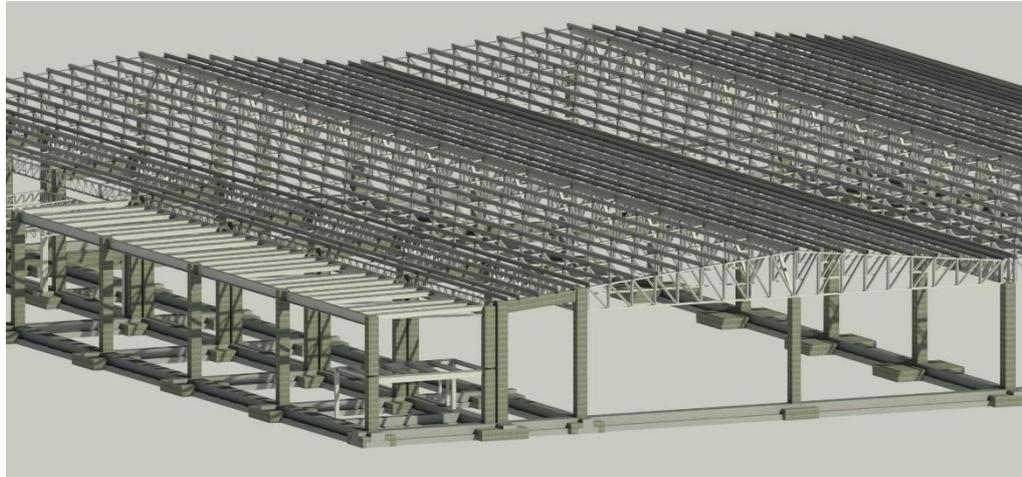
Armazón estructural del Almacén Industrial, fuente Modelo estructural propia
